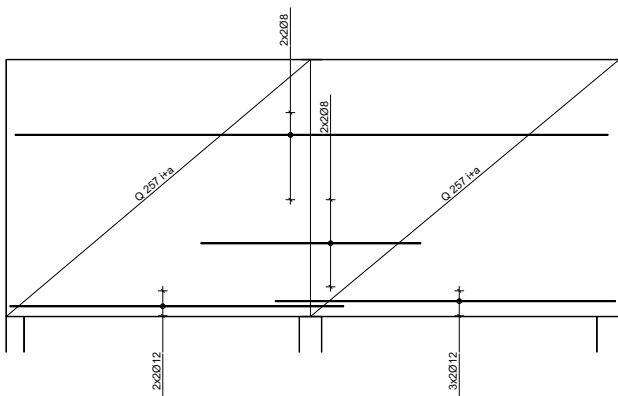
Bewehrungswahl im BauStatik-Modul S360.de
